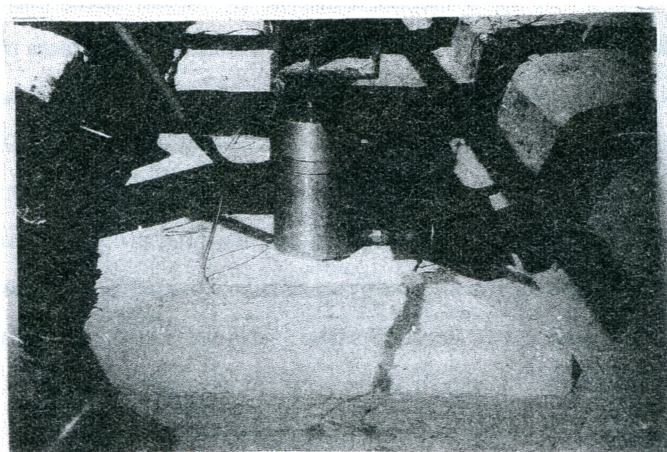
Осадка фундамента после приложения расчетной нагрузки.
